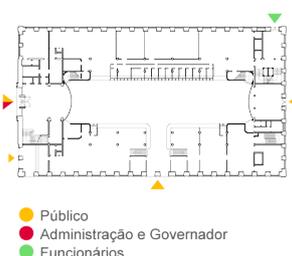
Planta com indicação das entradas do edifício, 1952
